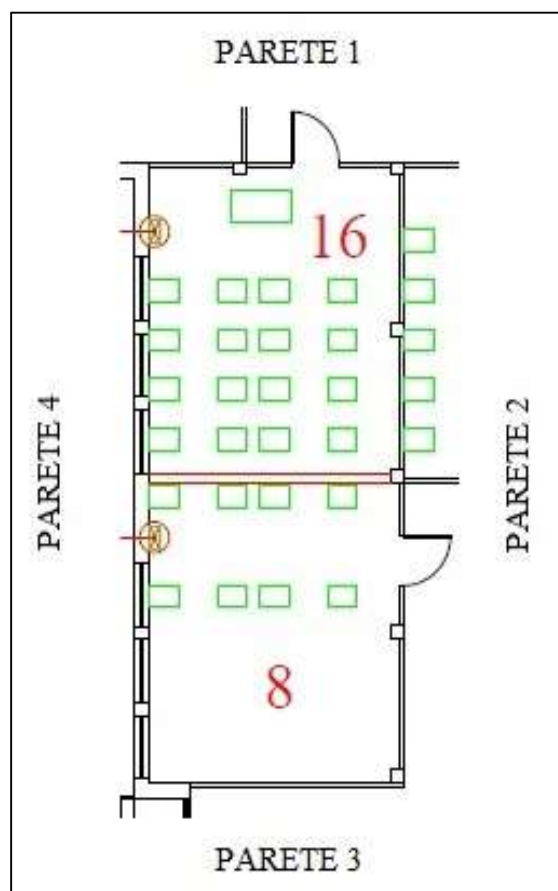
Planimetria dell'Aula 8-16 (Mensa) oggetto di misurazioni
